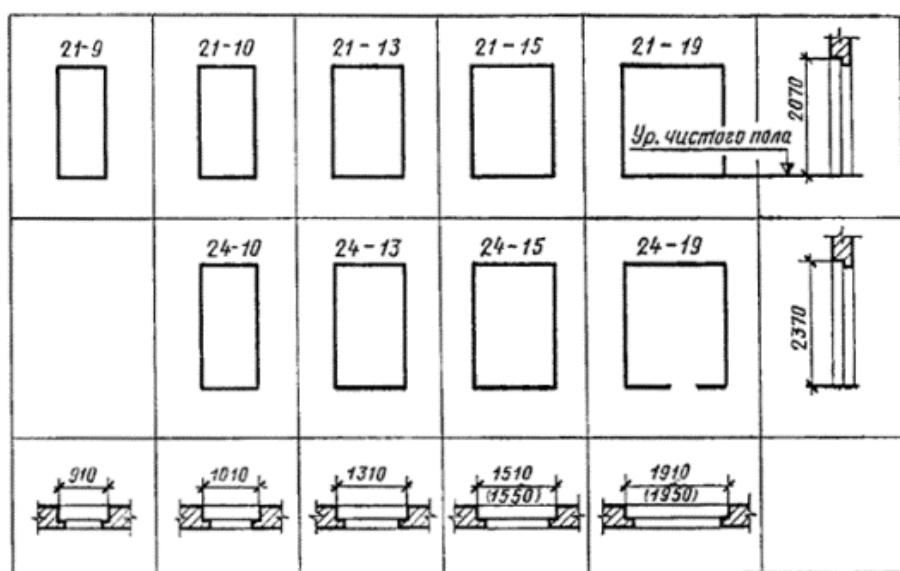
Размеры дверных проёмов в наружных стенах (ТИП Н)
